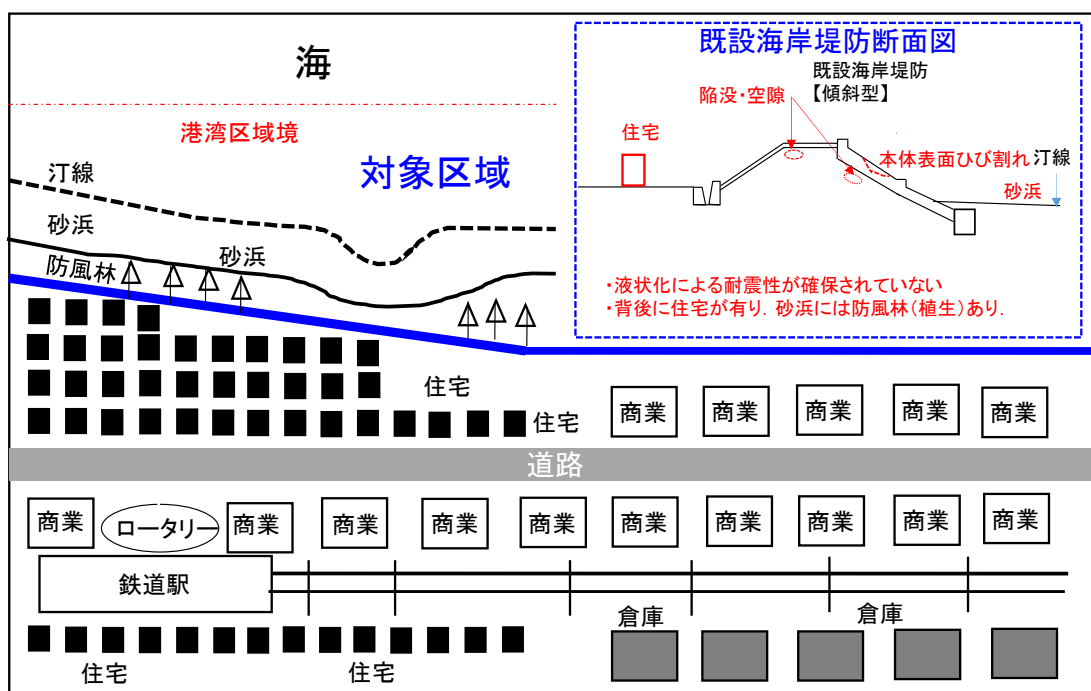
改良対象とした海岸堤防の現況平面図と断面図
